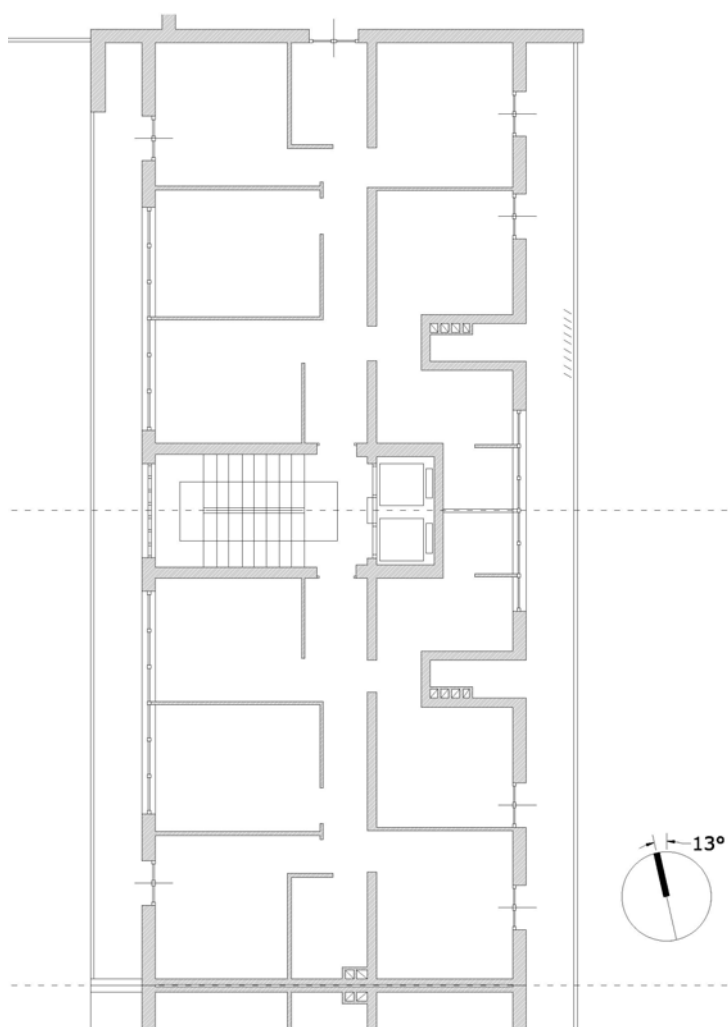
Planta tipo del bloque de viviendas sito en Paseo de los Olmos 26
